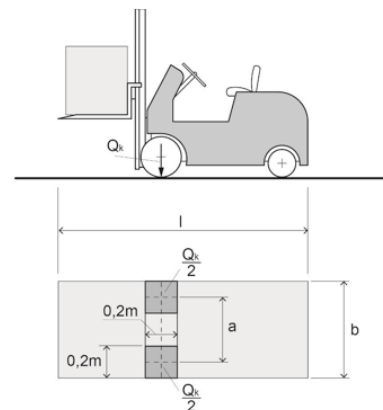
Dimensões de empilhadeiras ou minicarregadeiras
